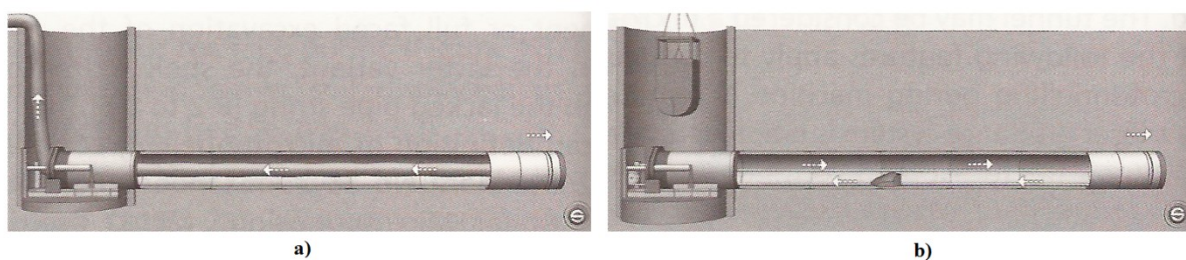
a) Schéma dopravy zeminy šnekovým dopravníkem, b) Schéma hydraulické dopravy zeminy [7]
